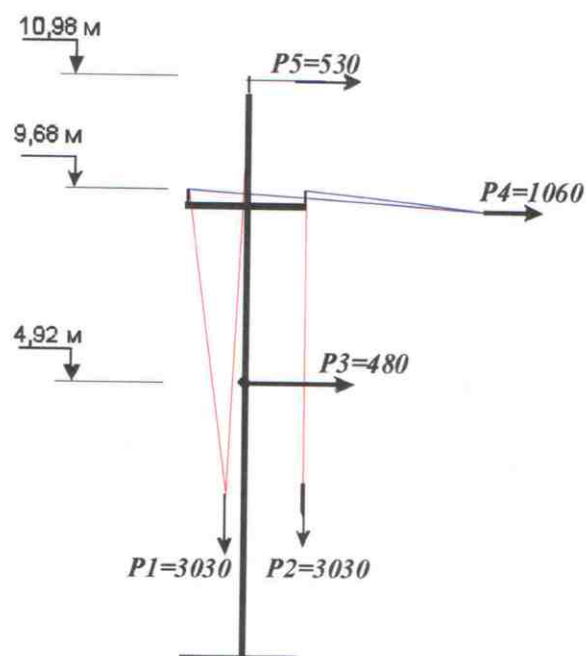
Сборка стеклопластиковой промежуточной опоры для ВЛ 6 - 10 кВ
